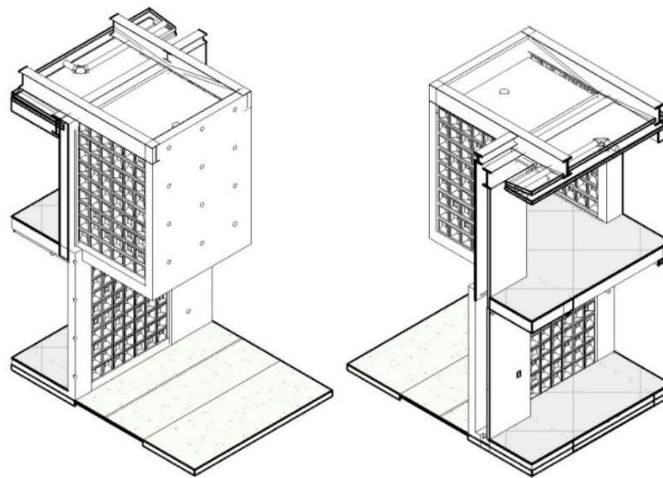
Fachada de estudio (Modelo 3D Revit Ecovilla)
